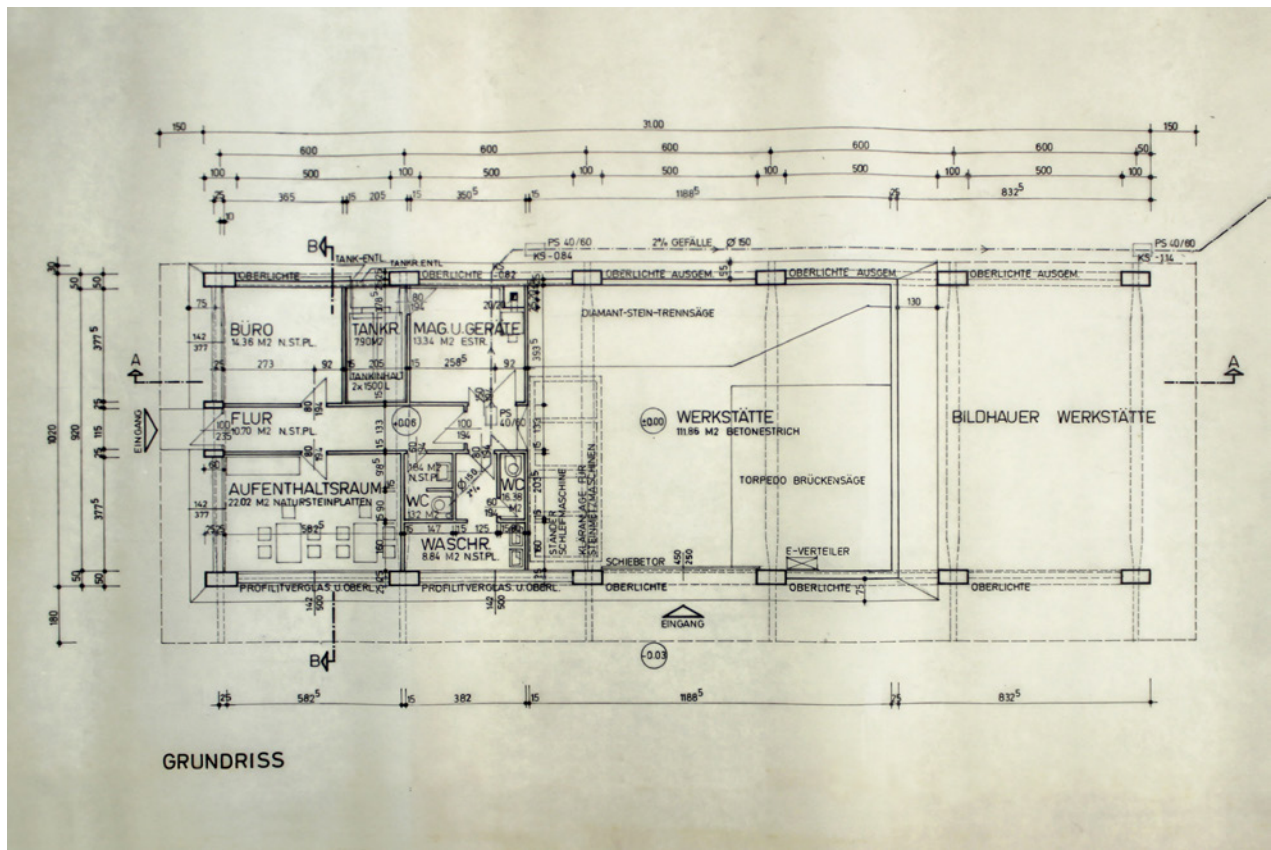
Grundriss Ausführungsprojekt, 16.12.1969
